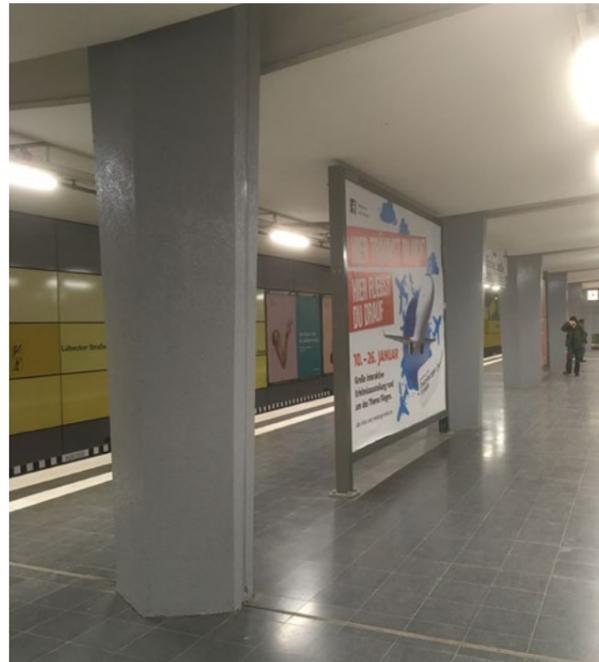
Hamburg, Wandsbeker Linie, U-Bahnhof Lübecker Straße, sechseckiger Querschnitt der Tunnelstützen und Deckenform bauzeitlich 1961, Zustand 2018.
